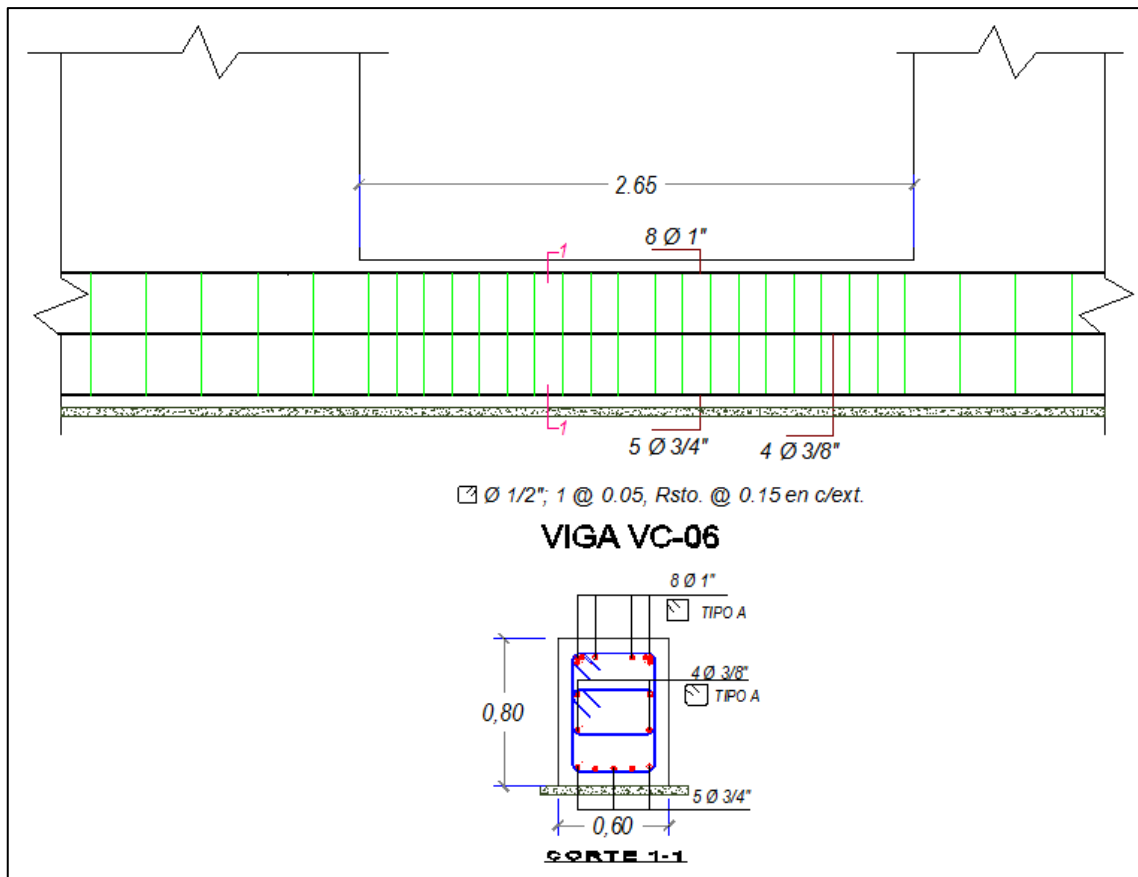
Esquema de requerimiento de estribos en vigas.
